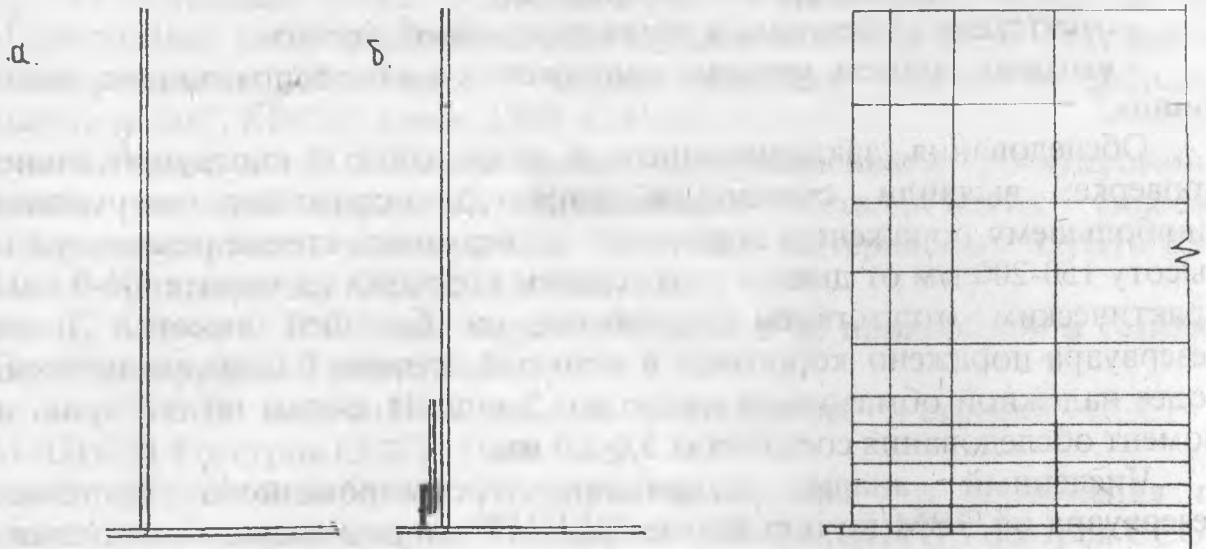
Расчетная схема узла сопряжения стенки с дном методом КЭ:
